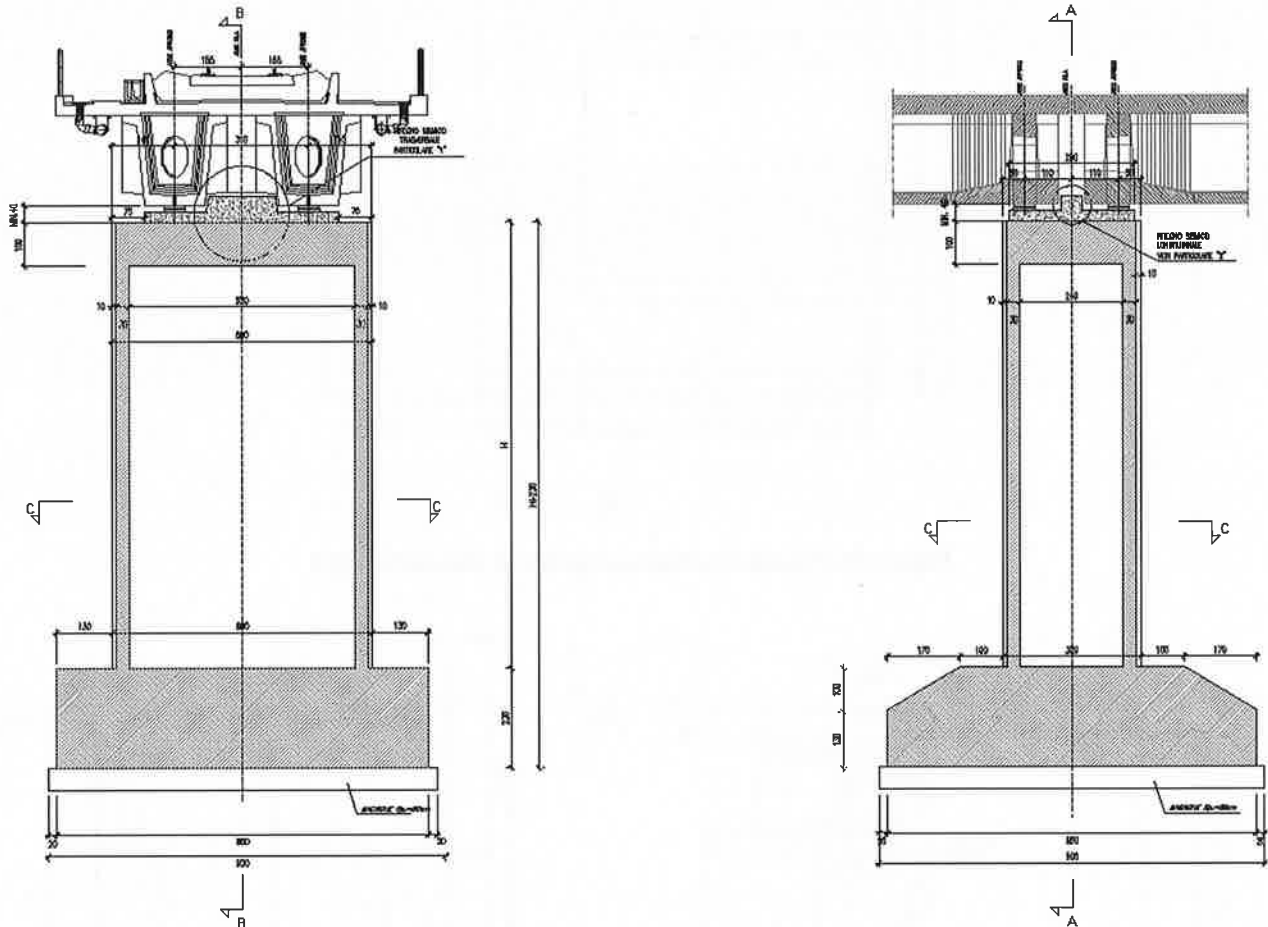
Sezione trasversale e longitudinale pila tipo Bauladu VI01
